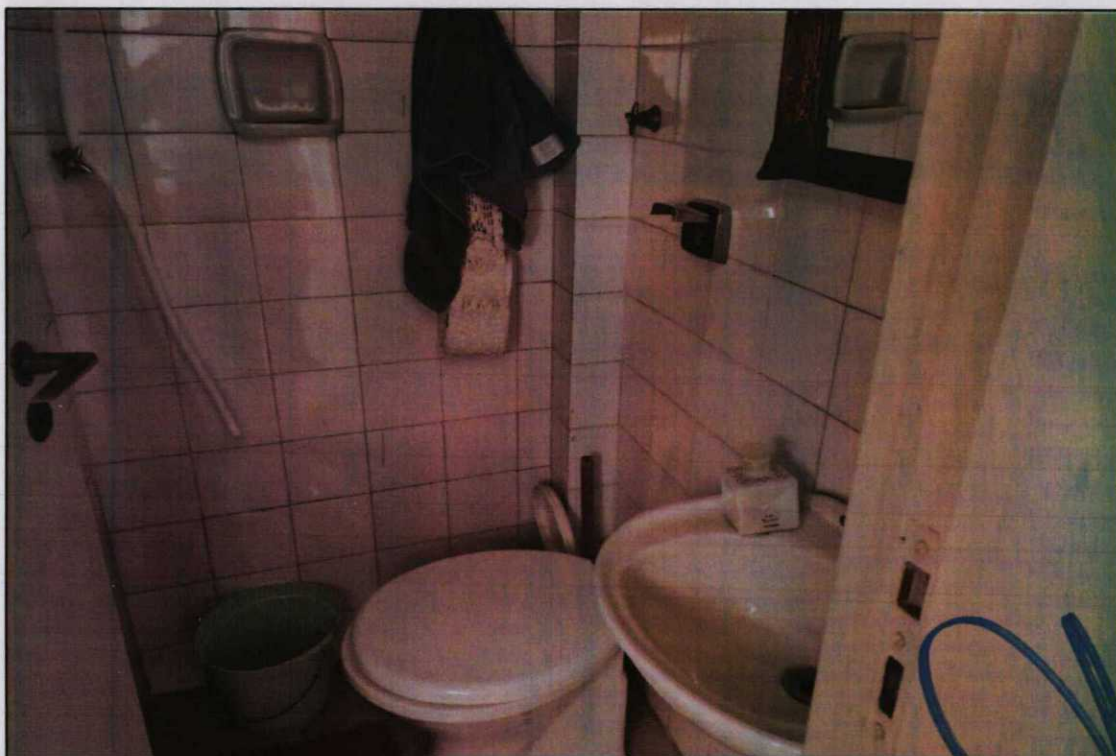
Vista do 1º banheiro no apartamento avaliando.
